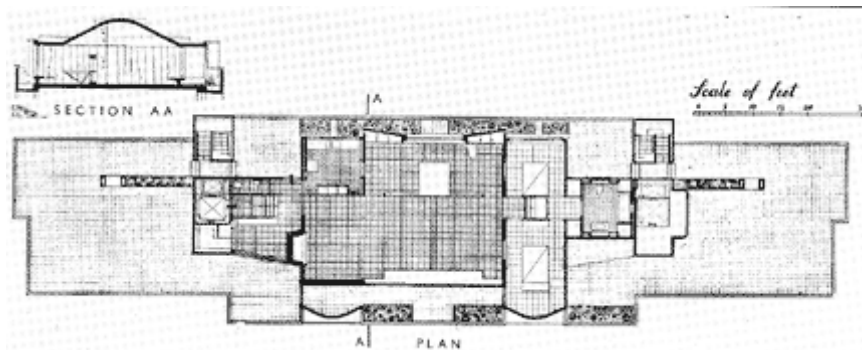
Penthouse Highpoint Two, Schnitt und Grundriss
